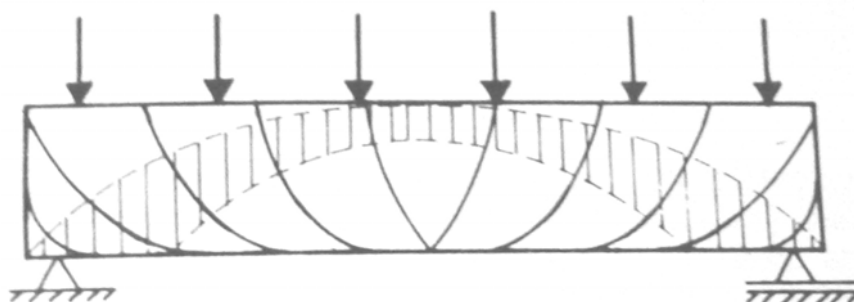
Viga isostática submetida à flexão. (Fonte: THOMAZ)
